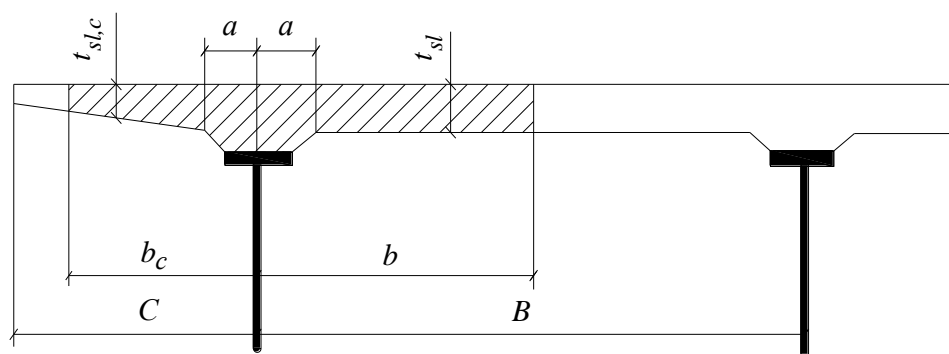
Схема для определения расчетной ширины железобетонной плиты, учитываемой в составе сечения
